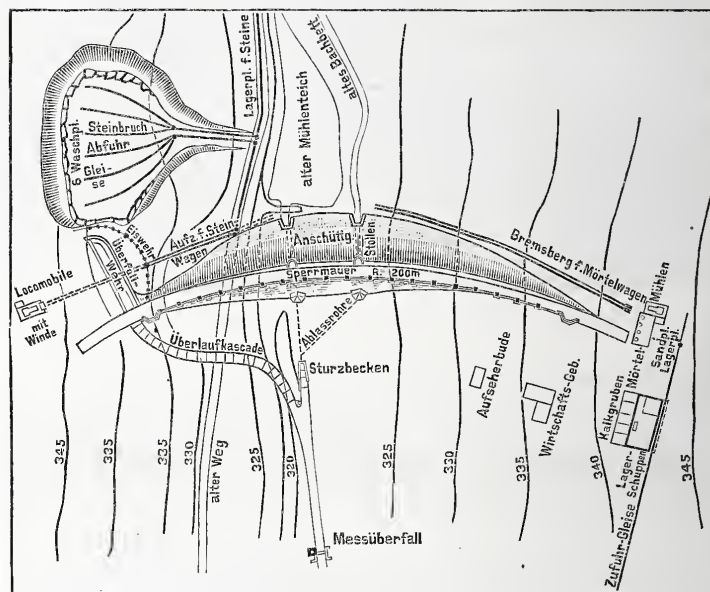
Lageplan der Sperrmauer mit den Einrichtungen für den Baubetrieb. (Maßstab 1:2500.)
